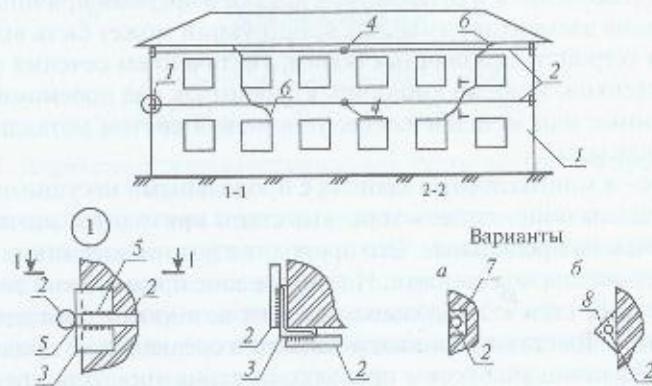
Усиление стен устройством напряженных металлических поясов с наружной стороны здания:
